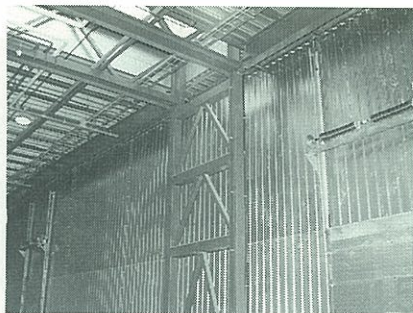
Gevelkolom landzijde, onderdeel van stabiliteitsconstructie
